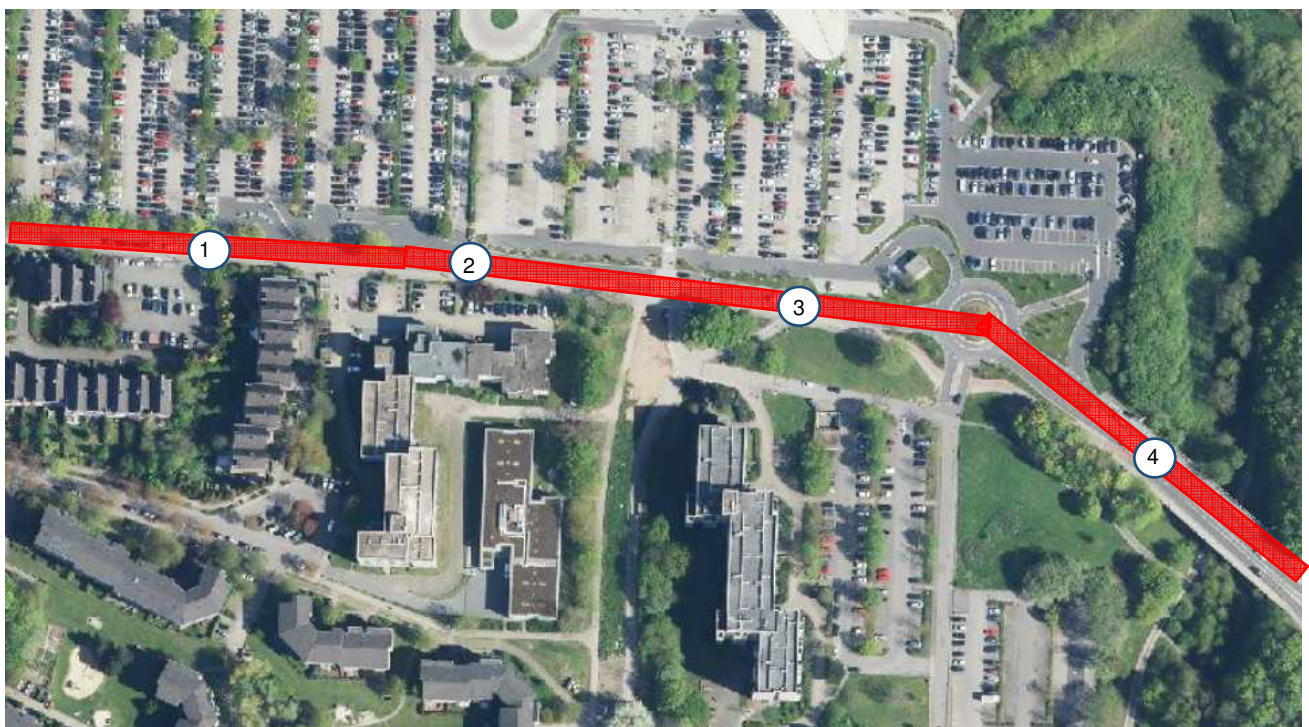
Lageplan mit gekennzeichnetem Abschnitten der Kullenhofstraße
